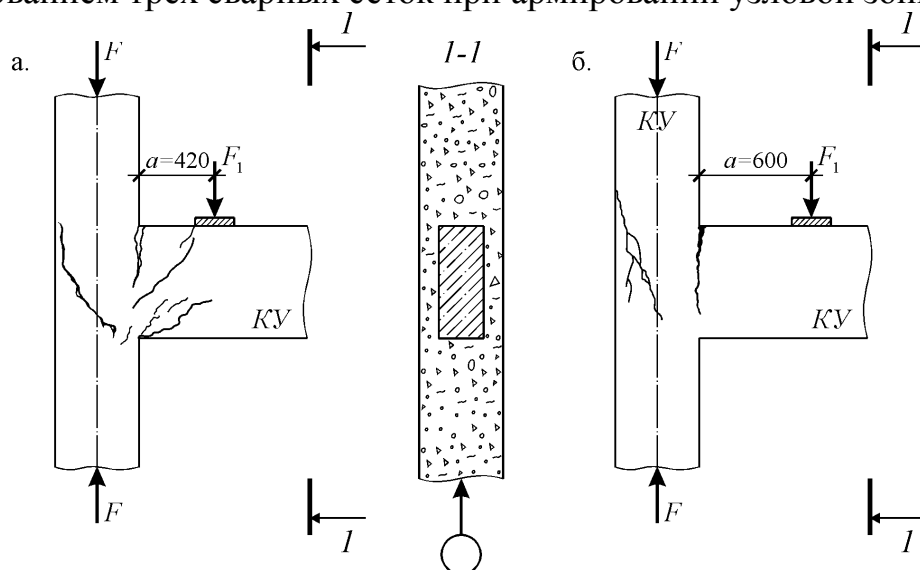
Схемы образования трещин и схемы разрушения узловых сопряжений железобетонных конструкций (Пензенский ИСИ, 1984 г.): а – при $a=420$ мм; б – при $a=600$ мм
